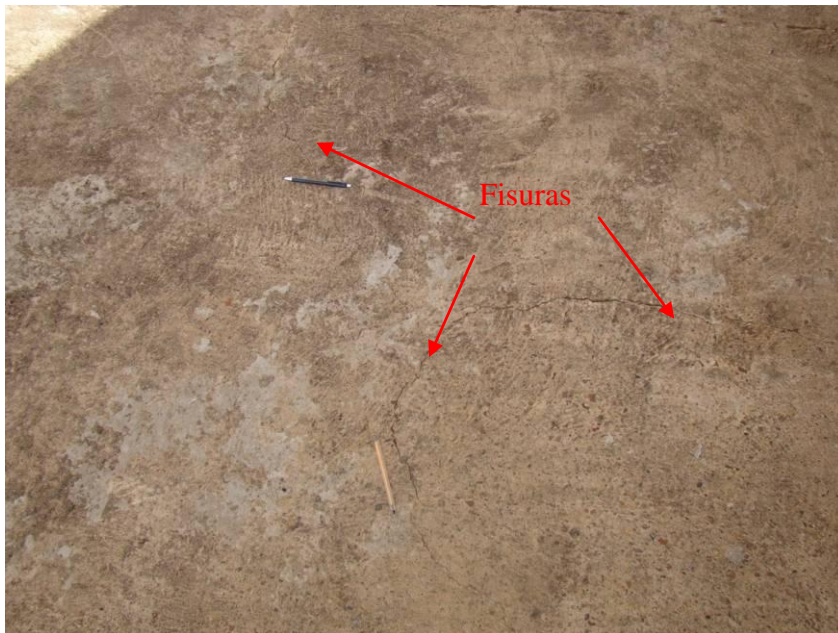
Fisuras en el cabezal de la Pila 11.
